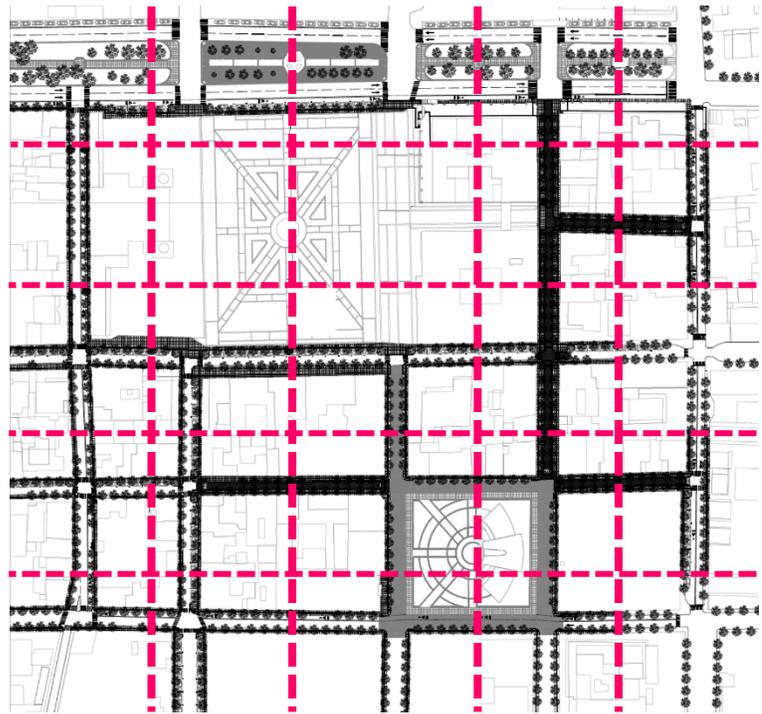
Secciones del plano clave. Fuente: Elaboración propia.
